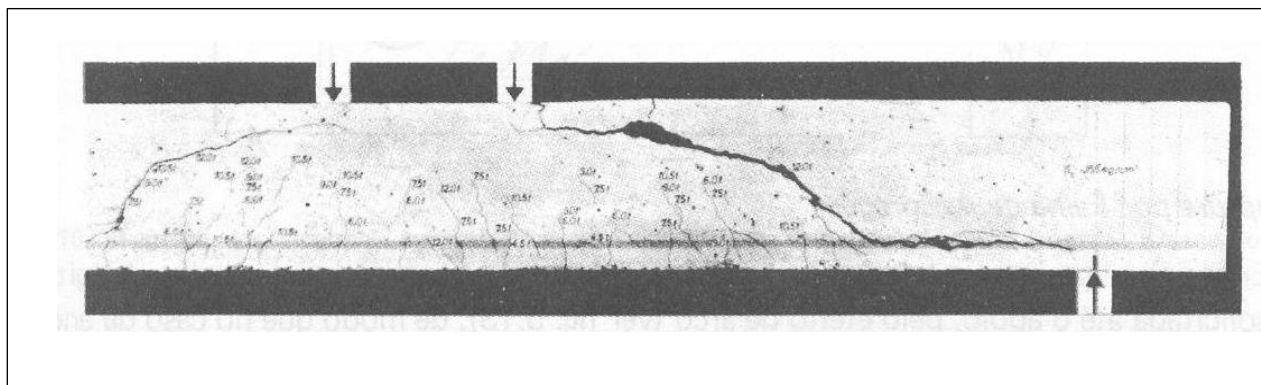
Rompimento de viga e laje por rompimento do banzo superior comprimido de concreto.
